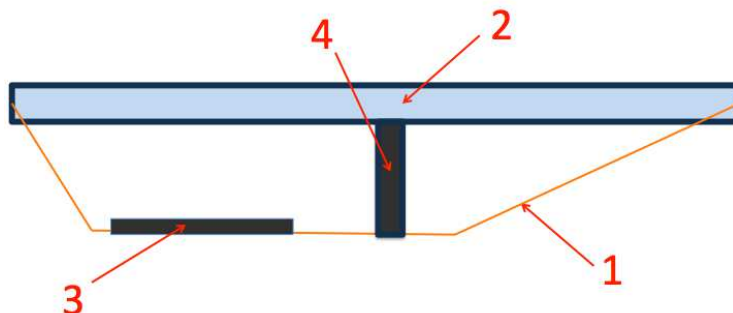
Elevação longitudinal de uma ponte-canal longa (2, 4) para travessia sobre uma estrada (3) e um canal (1).
